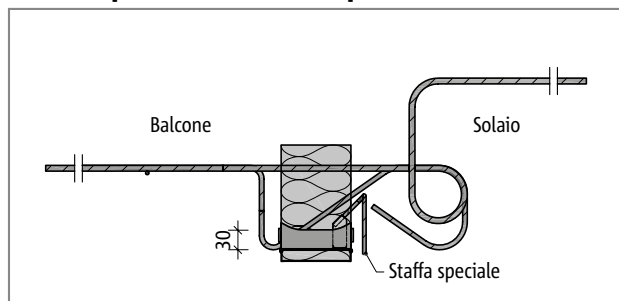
Schöck Isokorb® tipo KXT65-HV: sezione dell'elemento
